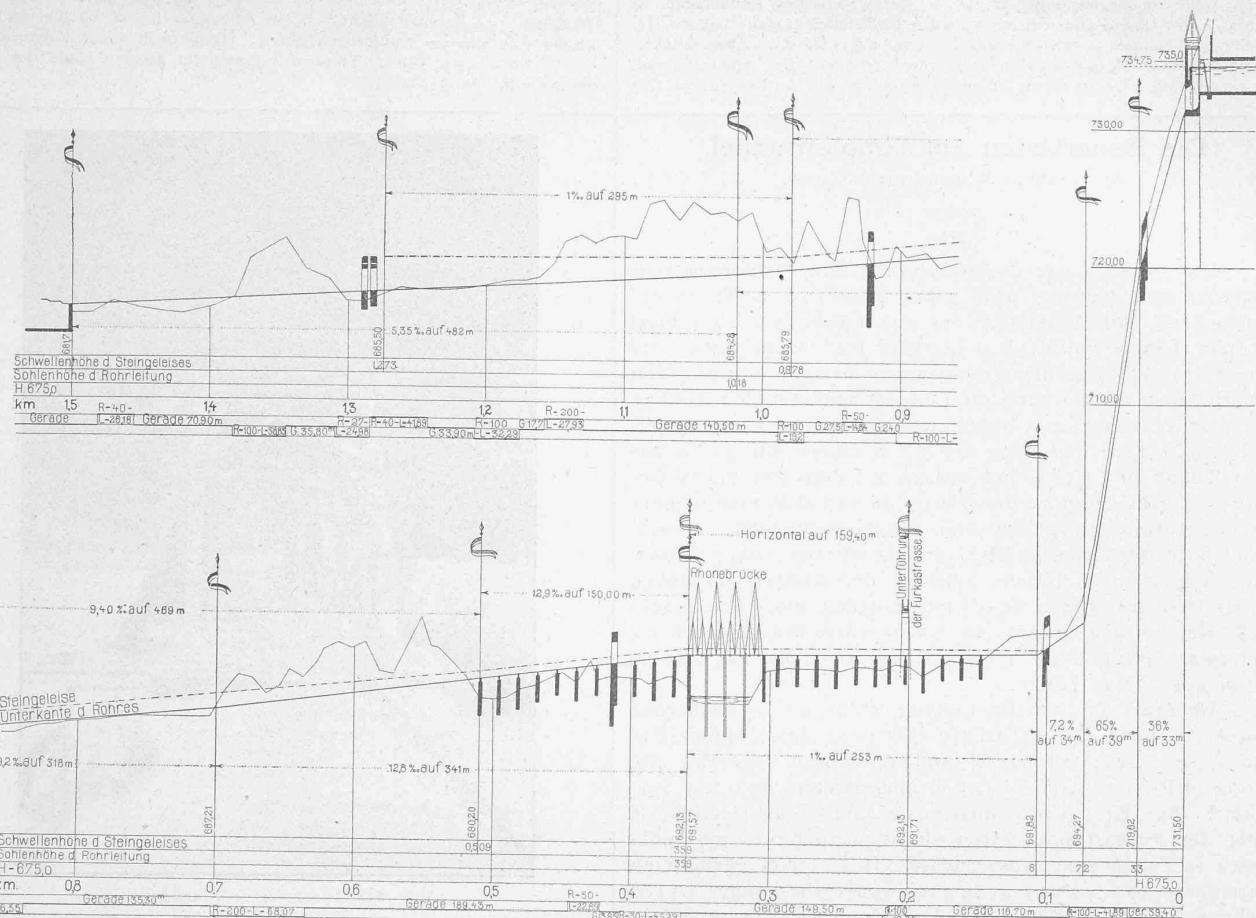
Wasserkraftanlage. Längenprofil der schmiedeisernen Druckleitung. — Maßstab für die Längen 1:5000, für die Höhen 1:500.
